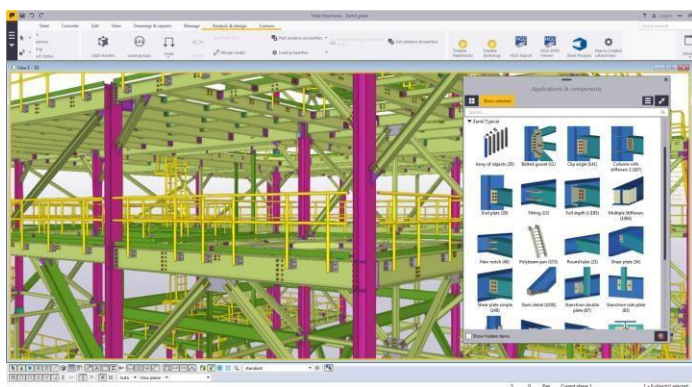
Interface do software TEKLA, em projeto predial de estruturas metálicas
